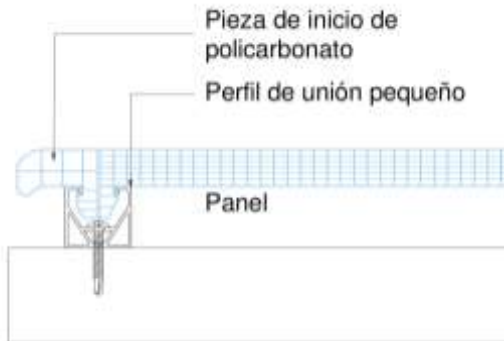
Detalle del encastre en el primer panel con perfil de unión.
